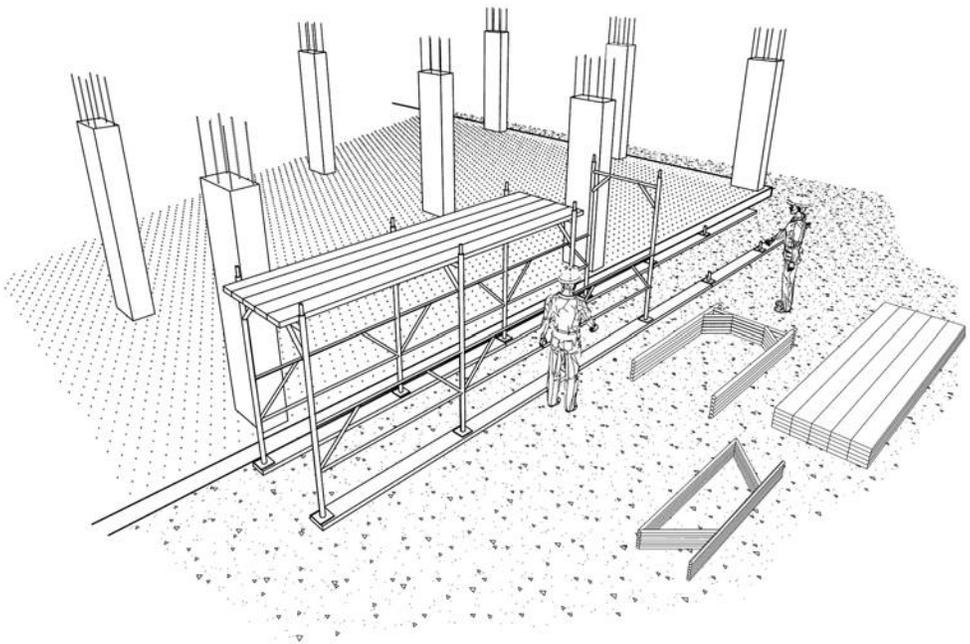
Ponteggio a telaio prefabbricato - montaggio primo e secondo piano
